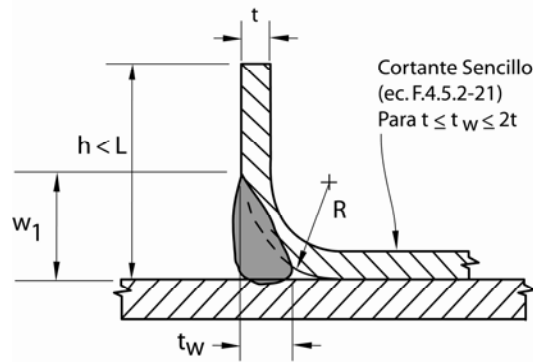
Soldadura abocinada en media V (Llenado a ras de superficie, $w_1 = R$)
